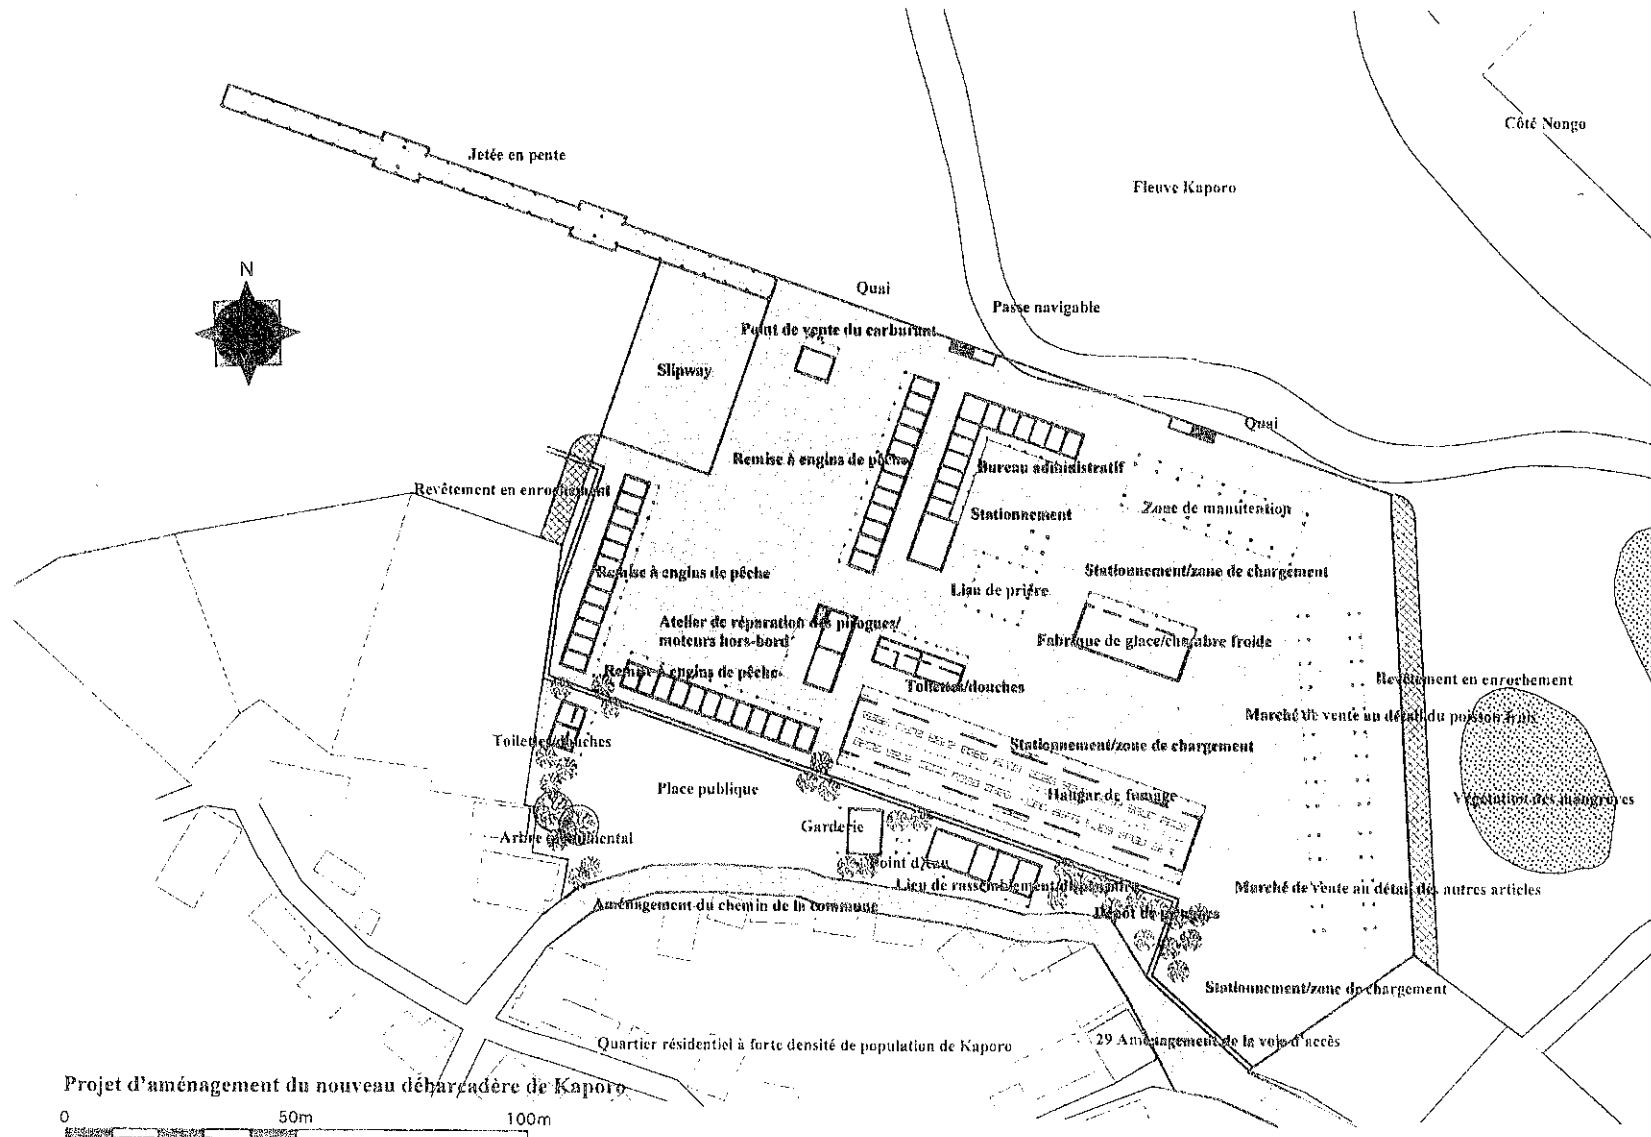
Plan d'aménagement du nouveau débarcadère de Kaporo (plan détaillé)
